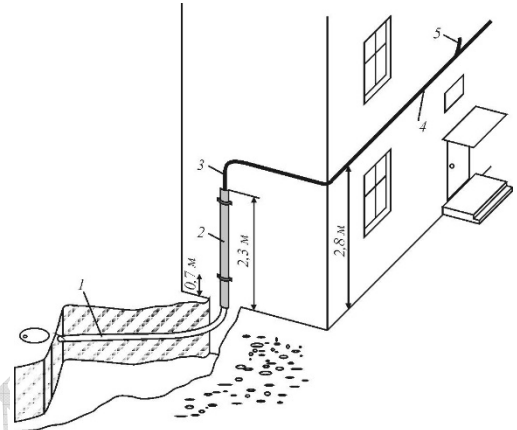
Вывод кабеля на наружную стену зданий и открытая прокладка по стене:
